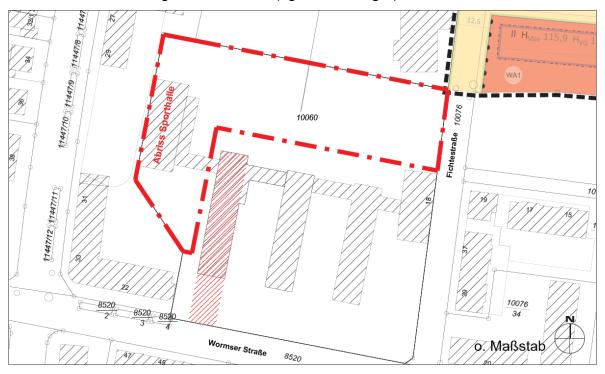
Möglicher Flächenzuschnitt bei Abriss der Sporthalle (Strich-Punkt-Linie)
